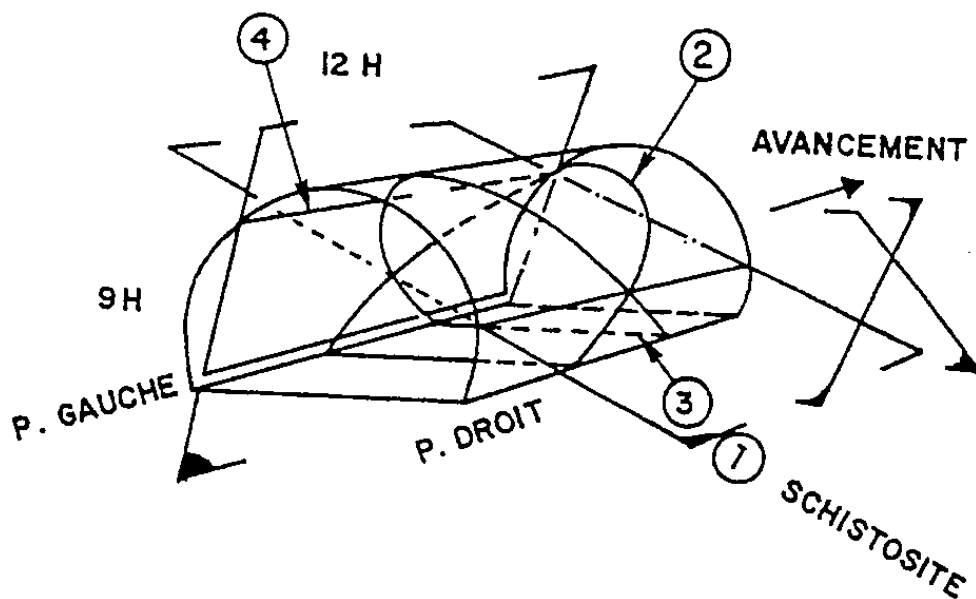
Discontinuità rispetto all'asse del traforo (direzione F->I)
